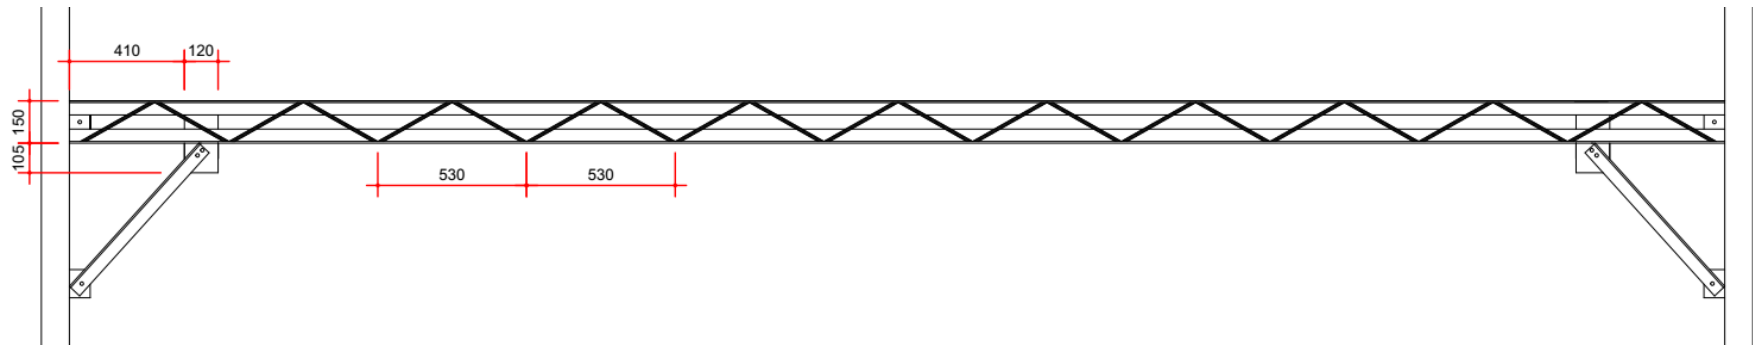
VISTA TÍPICA DO TRAVAMENTO (DIMENSÕES EM MM)
